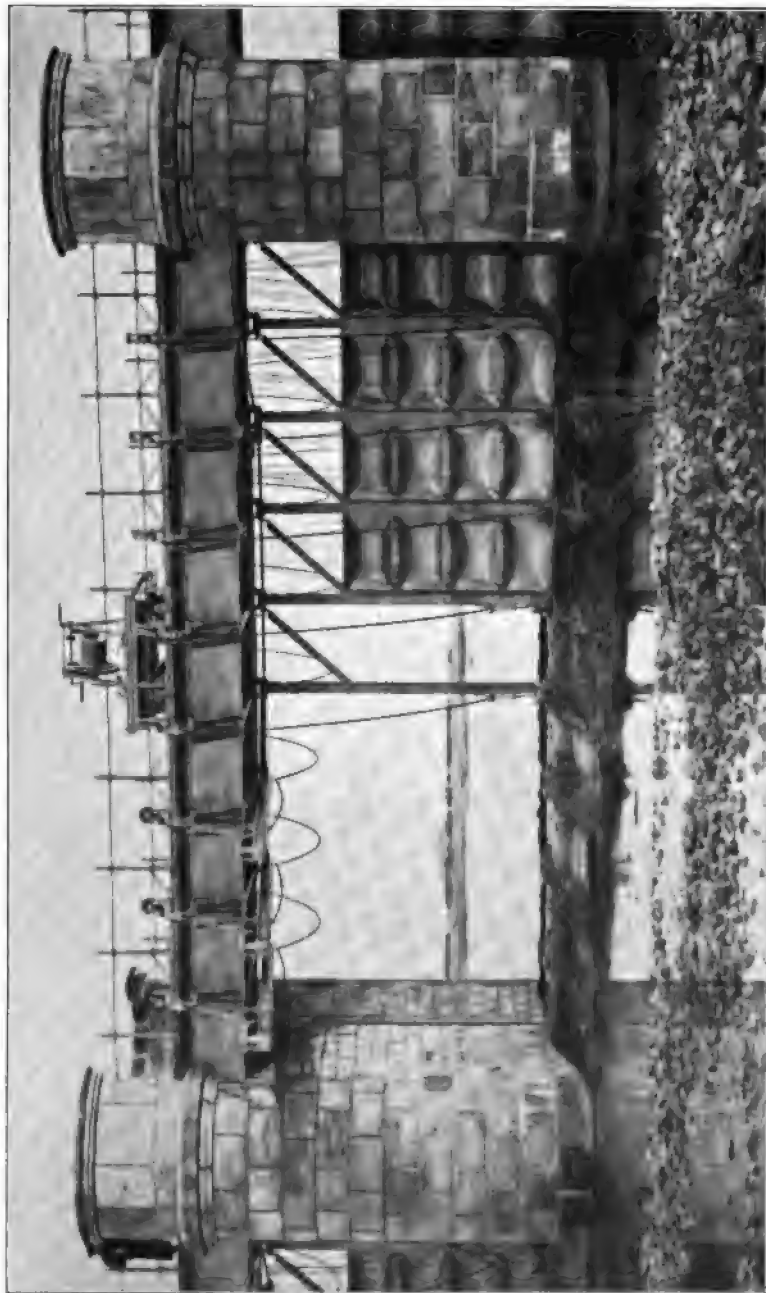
Ansicht einer Öffnung des Pretziener Wehres, von unterhalb gesehen.
